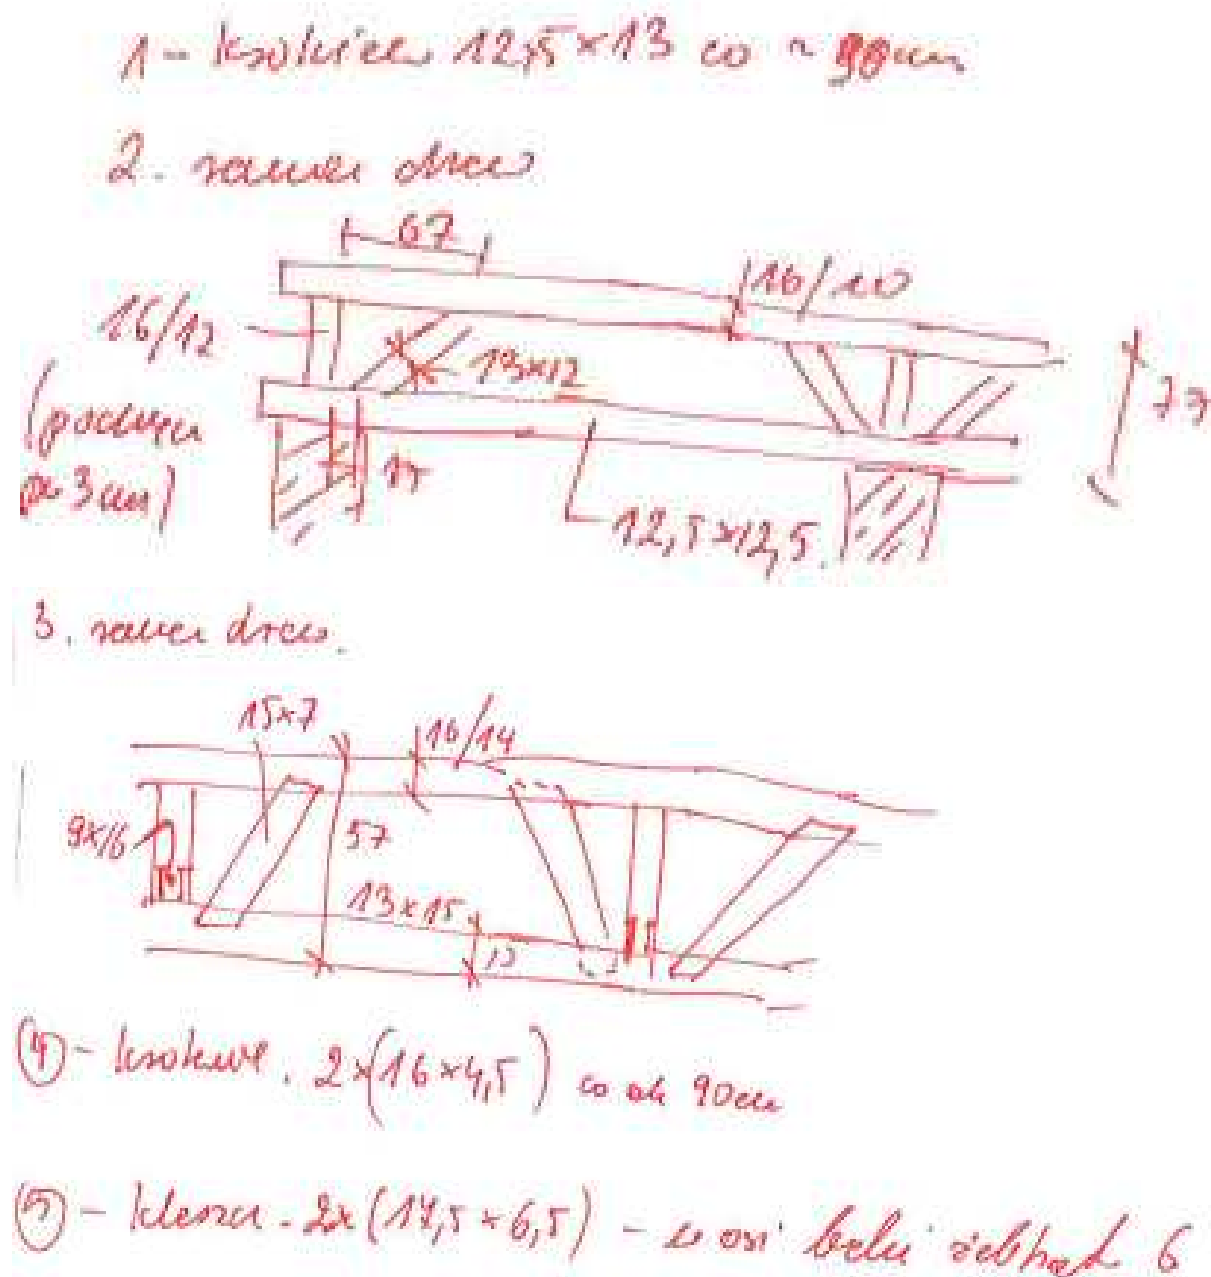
Drewniana konstrukcja dachu nad „Salą na Piętrze”
